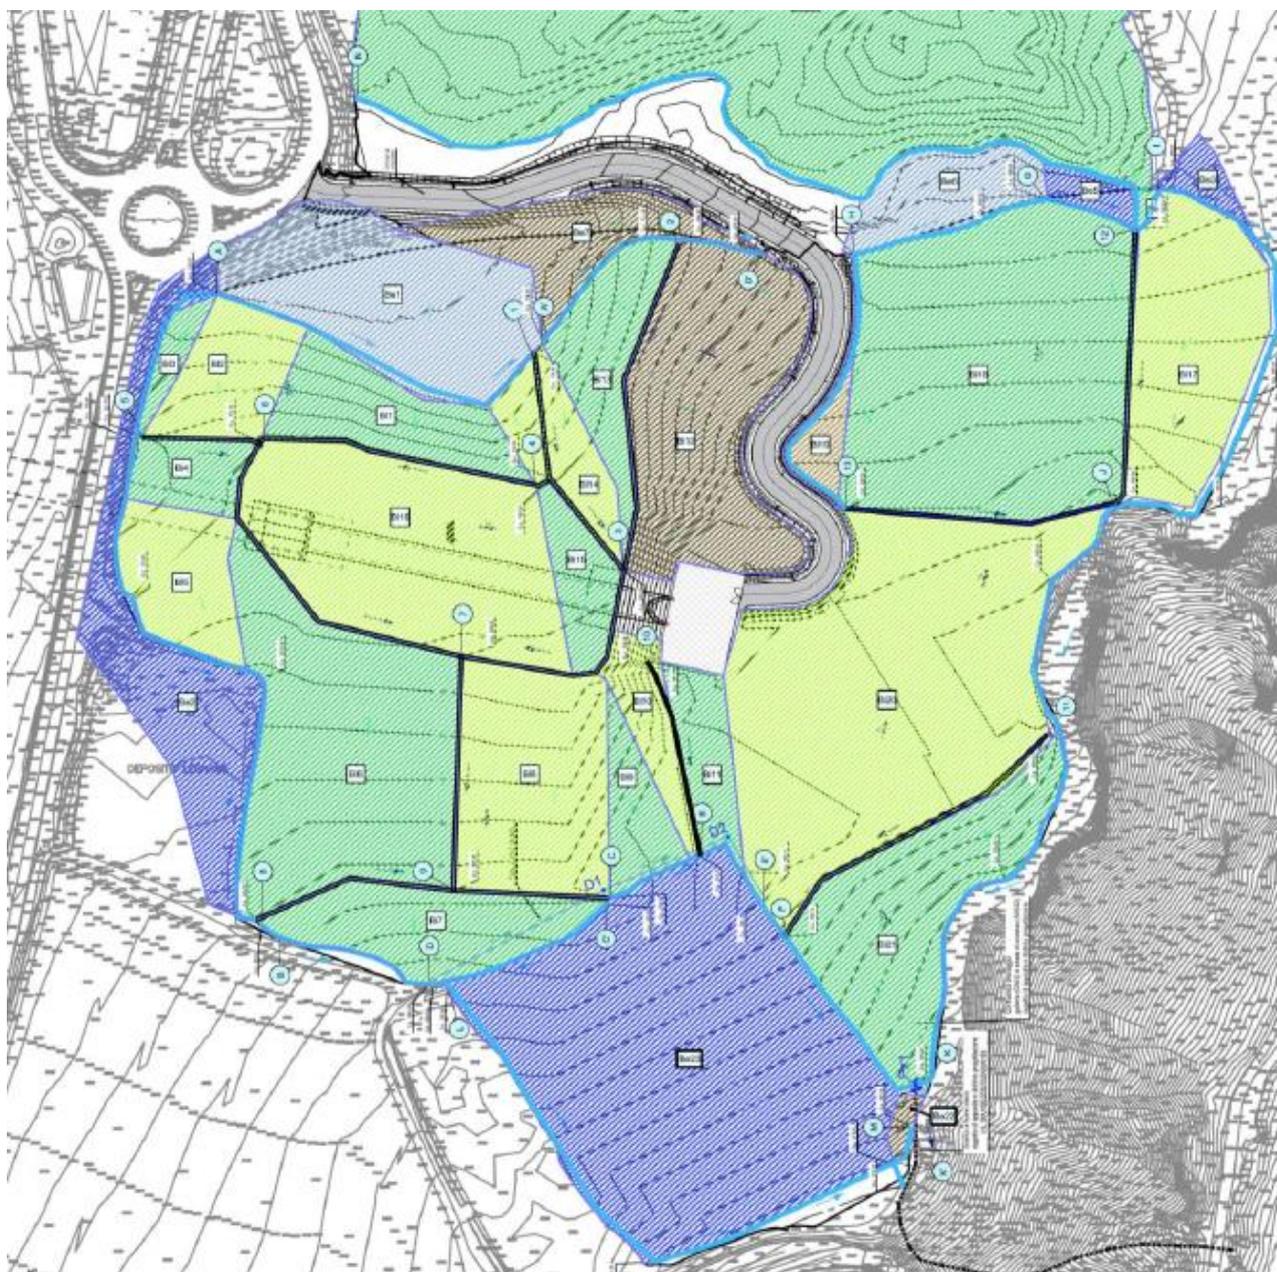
Planimetria idraulica dello stato finale dei luoghi
